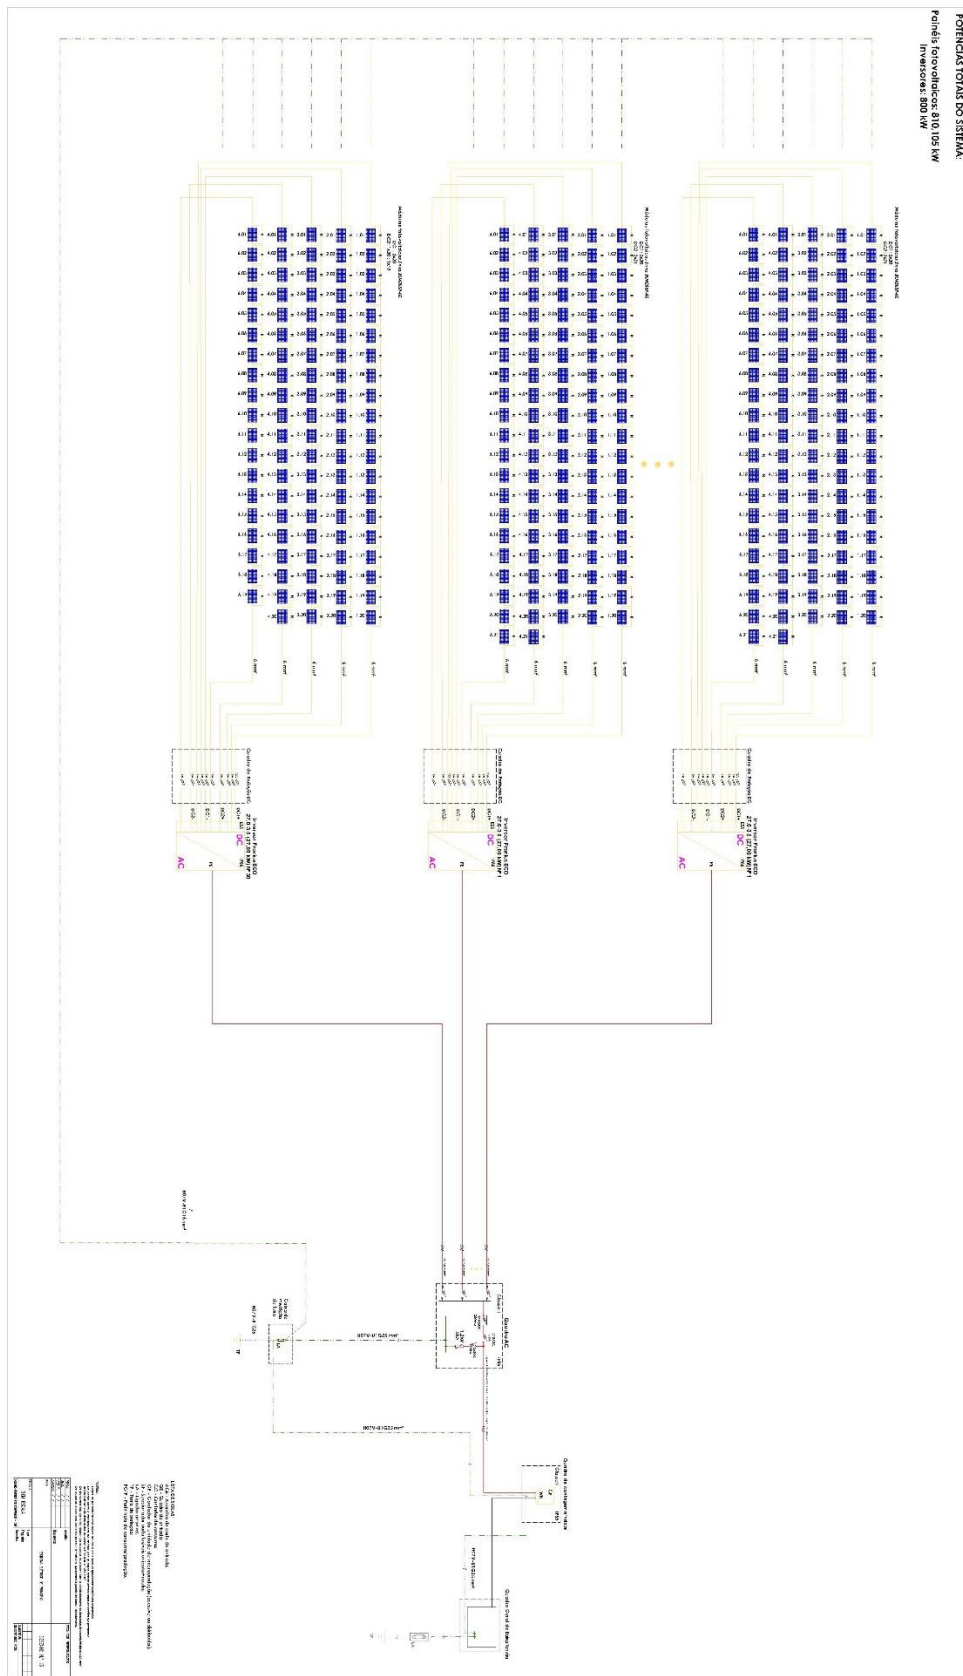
Desenho CAD do esquema elétrico da UPAC
